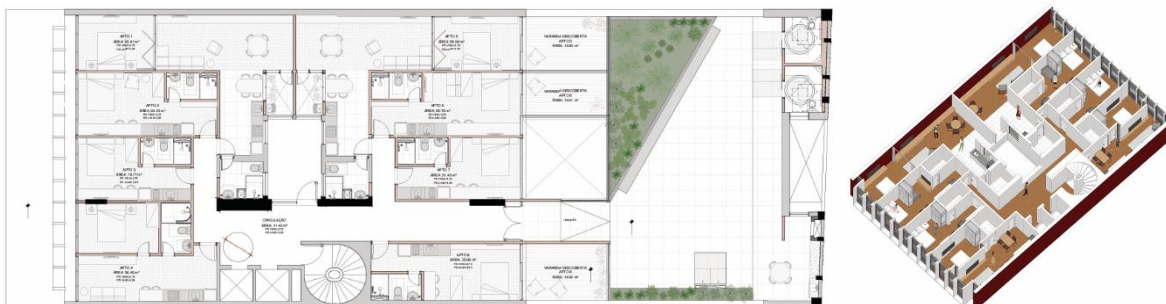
Planta 1º pavimento; Figura 14: Pavimento tipo. Fonte: Material cedido por SIAA Arquitetos para a realização da pesquisa em 2024.
